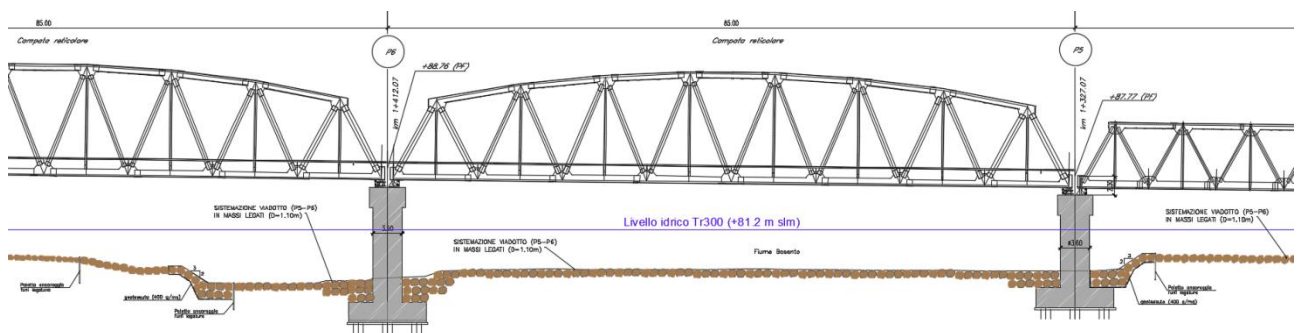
Fiume Basento: sezione del nuovo viadotto VI13 con opere di protezione.
